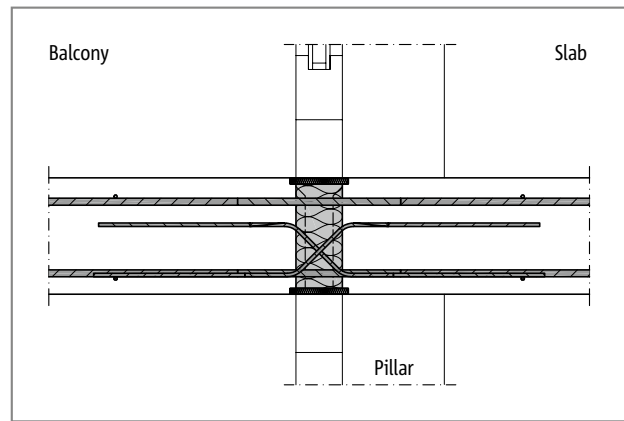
Schöck Isokorb® T type D: Installation section; flat slab
